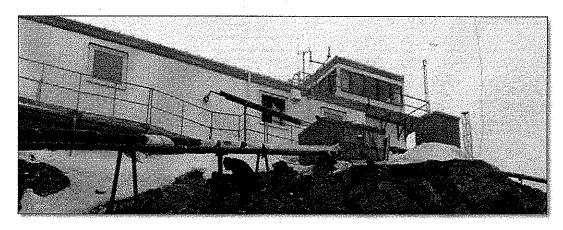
Se puede apreciar en la parte superior la pre cámara, el ducto de entre 10 a 15 metros de largo de PVC con aislación y calefacción y abajo, el módulo que contenía la planta de tratamiento.
